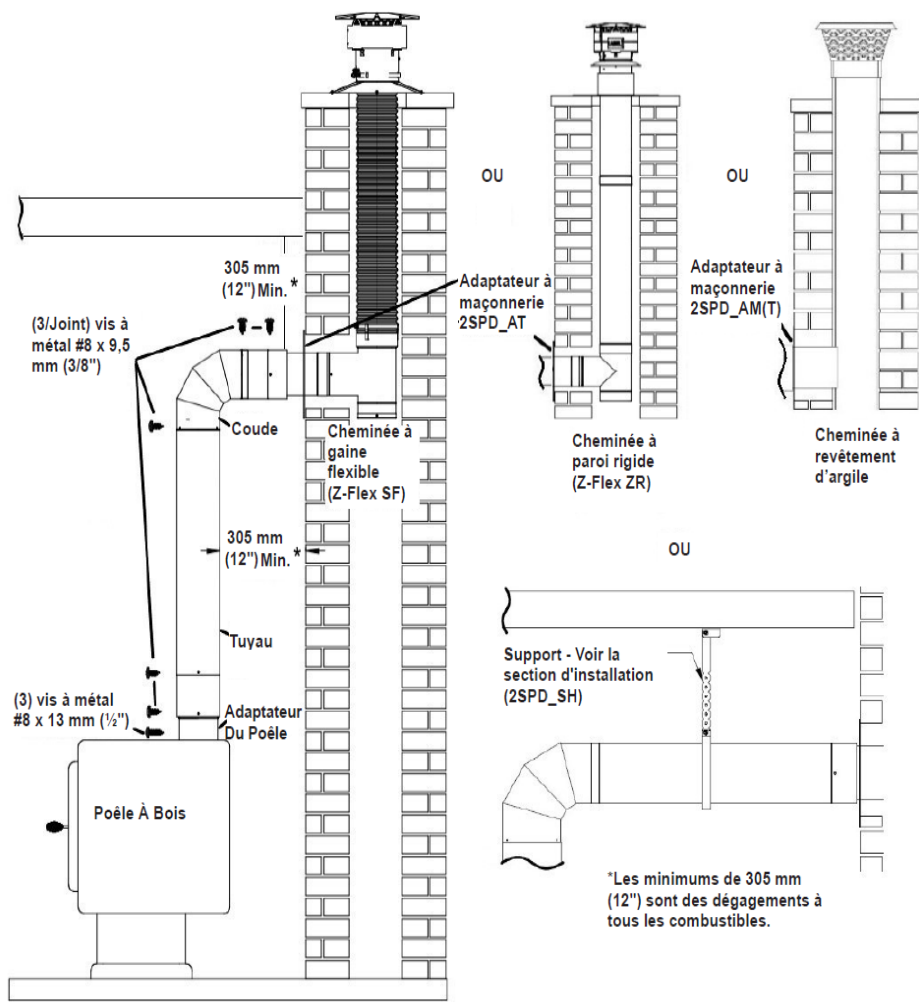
Installation d'un connecteur de cheminée à double paroi sur une cheminée à revêtement
